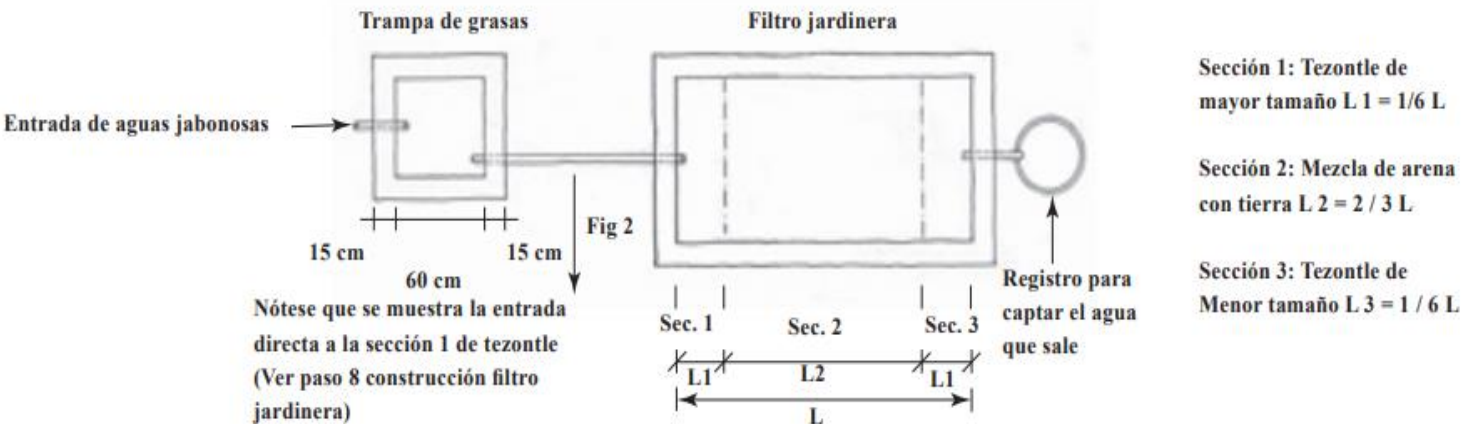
Planta esquemática de trampa de grasa + filtro de jardinera
